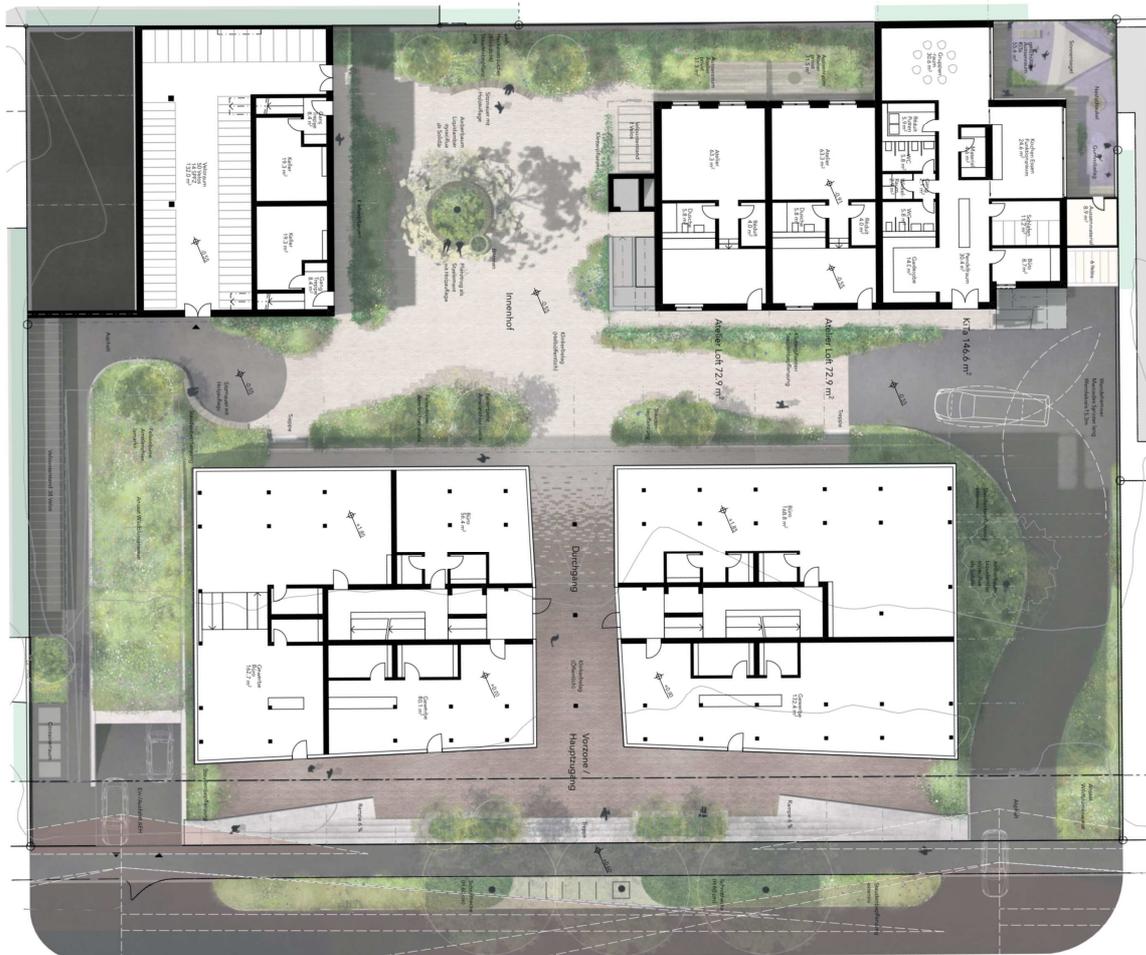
FaBiLe: Grundriss EG und Aussenraumkonzept (Beyeler + Trueb Landschaftsarchitekten GmbH)
